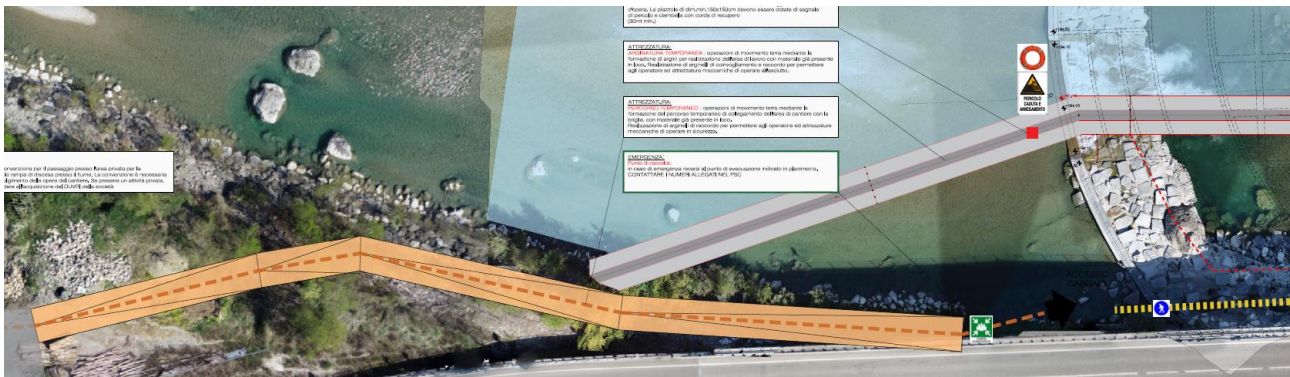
Estratto dell'allegato 7.6.2 Accantieramento e seconda fase d'intervento che individua un tratto della nuova porzione di pista di cantiere da realizzare per raggiungere il sito di intervento in destra idraulica
